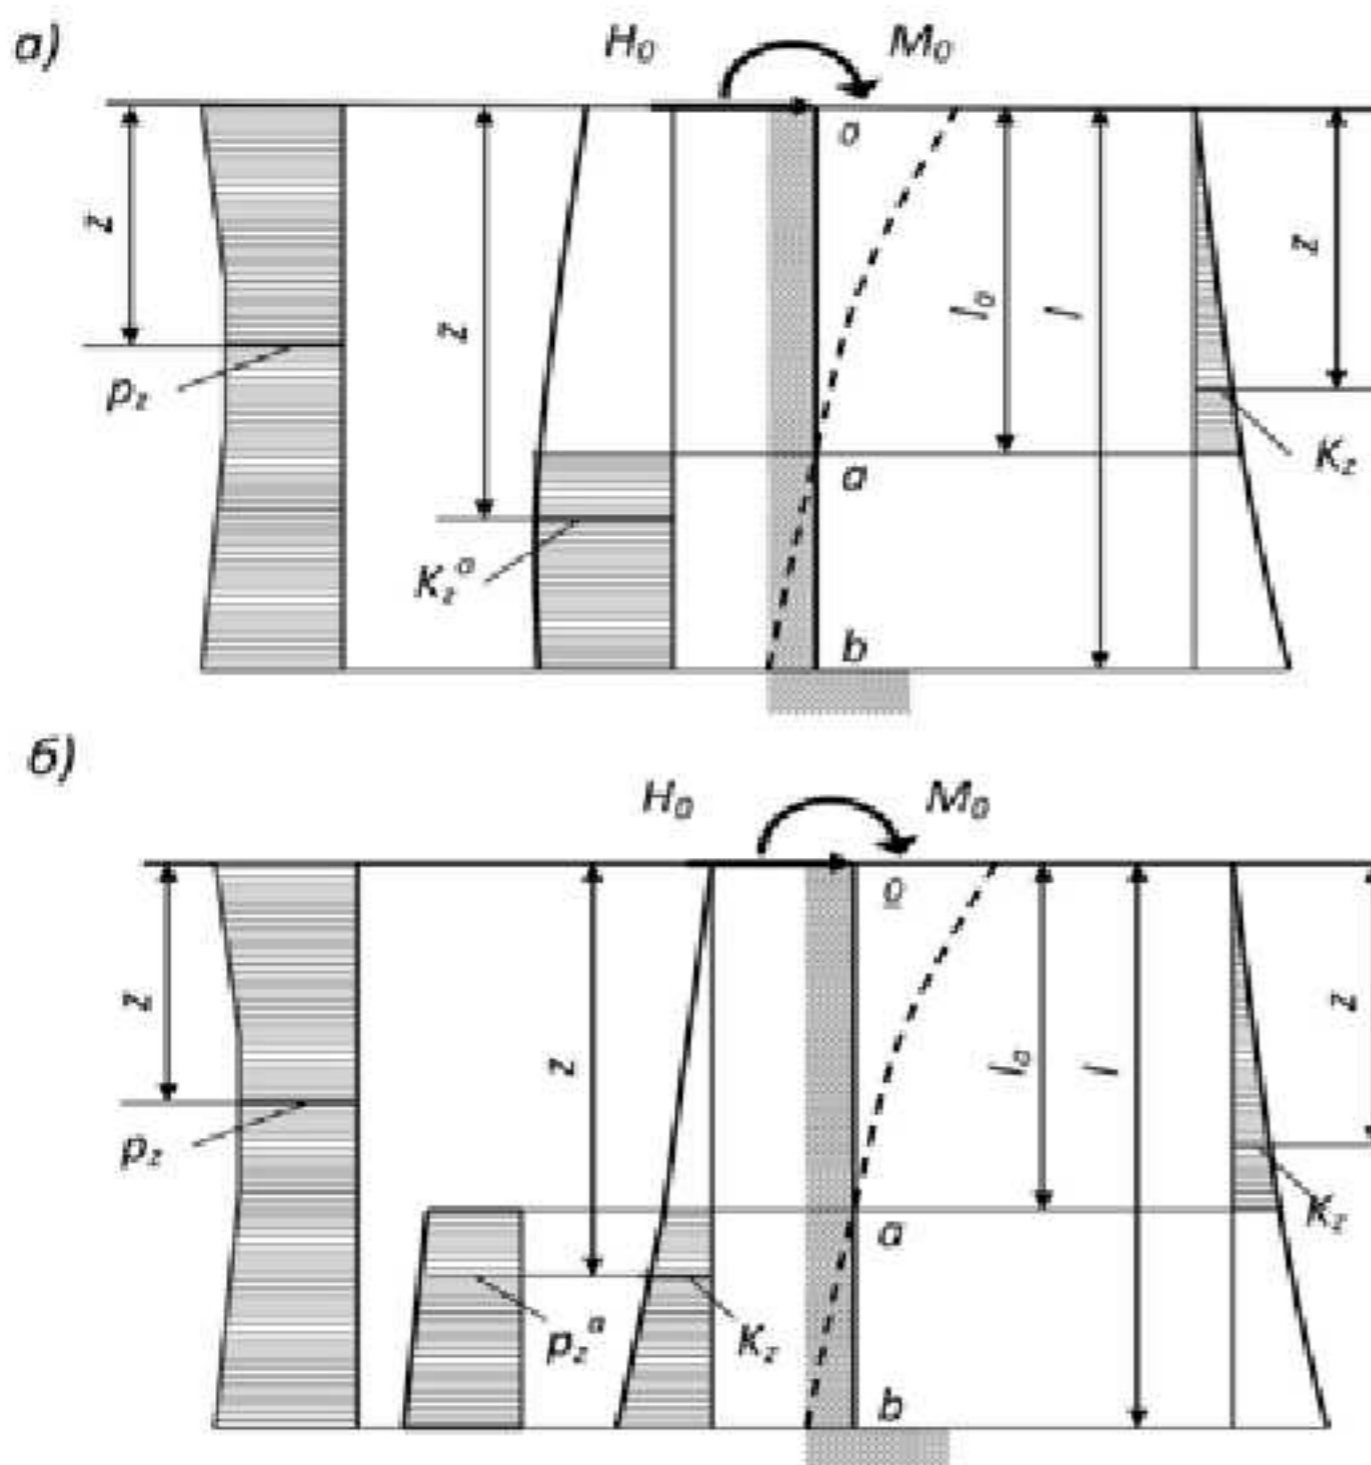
Расчетные схемы заглубленной части подпорной стенки:
